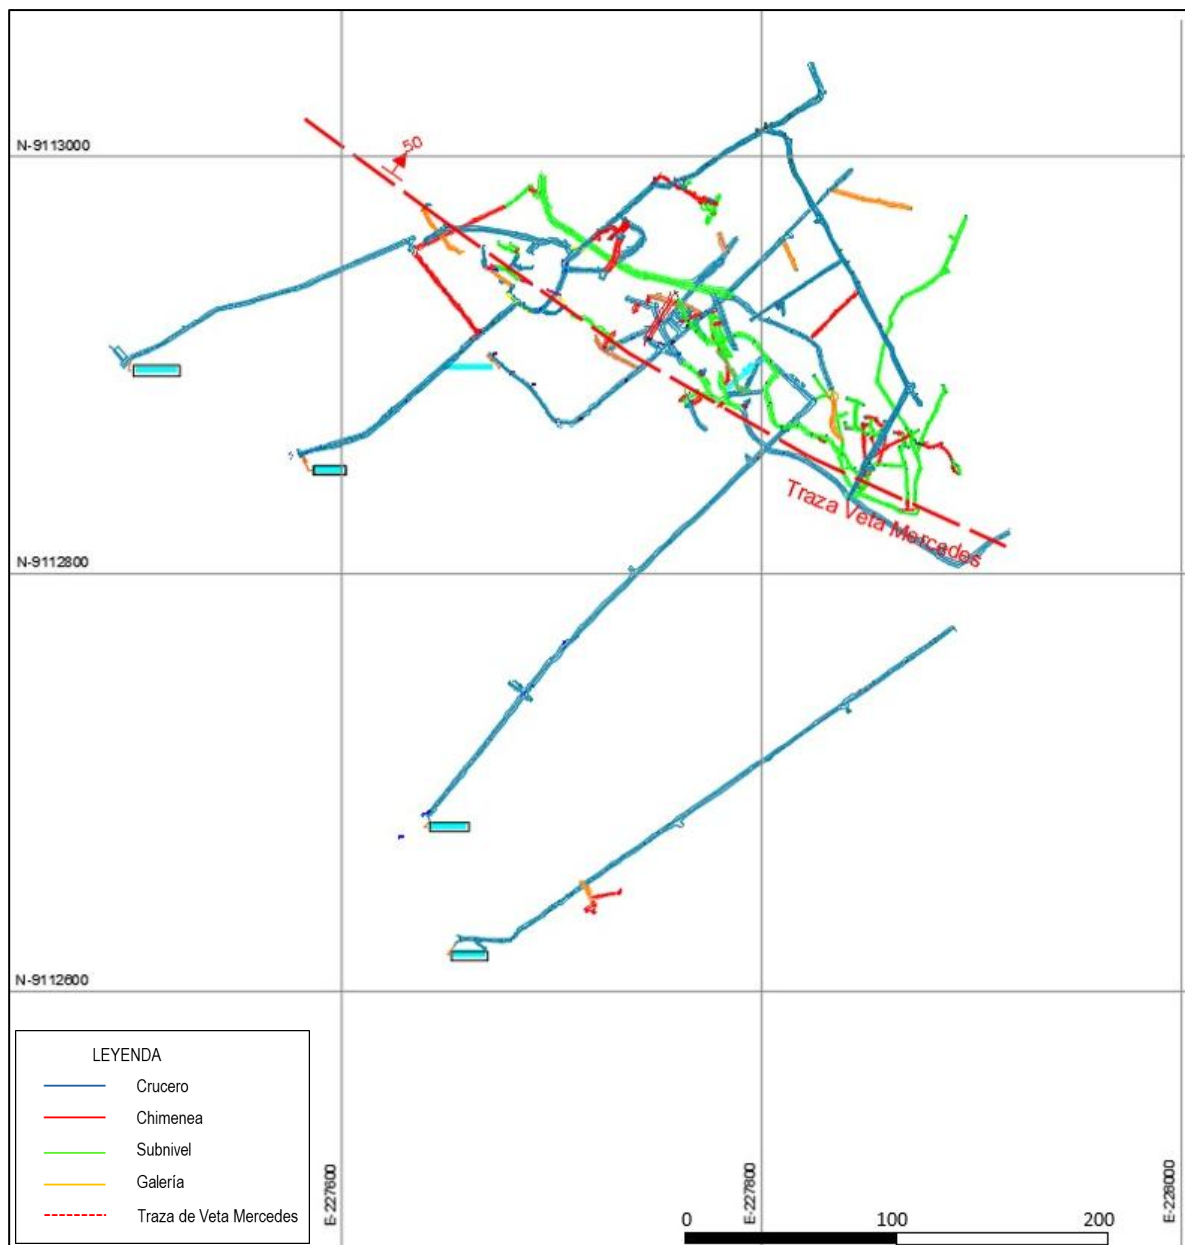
Proyección de Veta Mercedes - Vista en Planta
